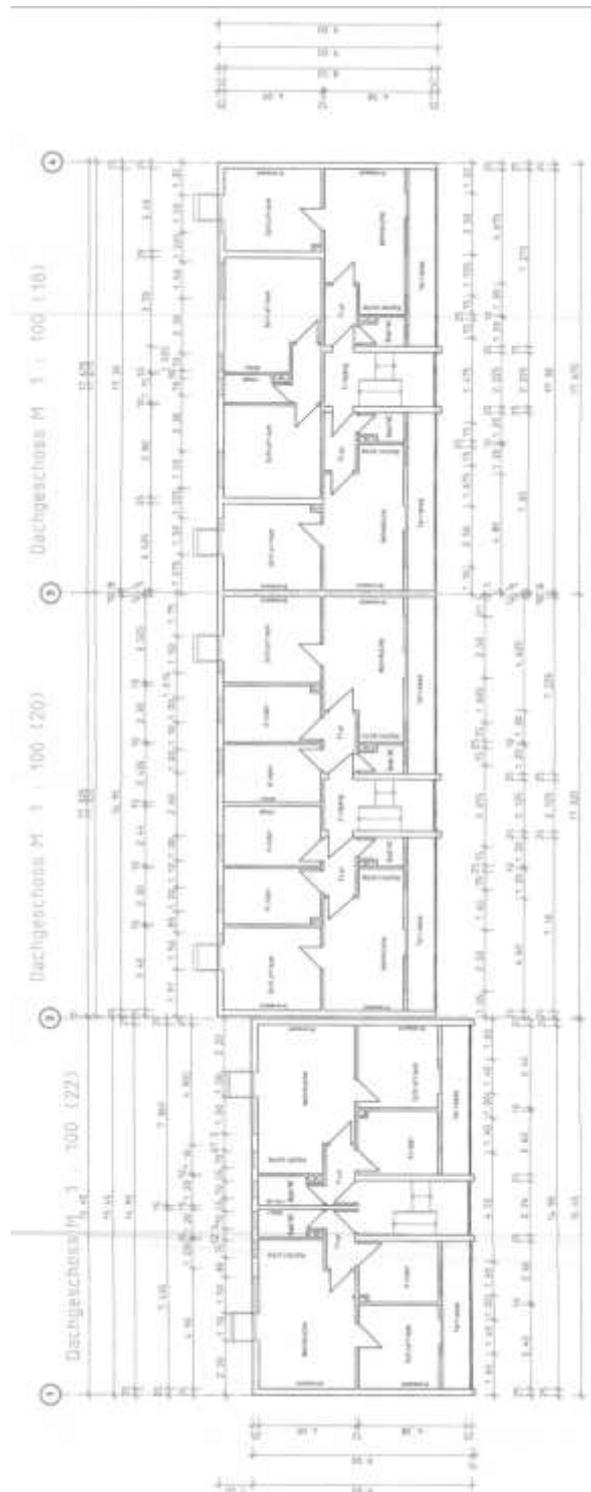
Grundriss Dachgeschoss (DG)
